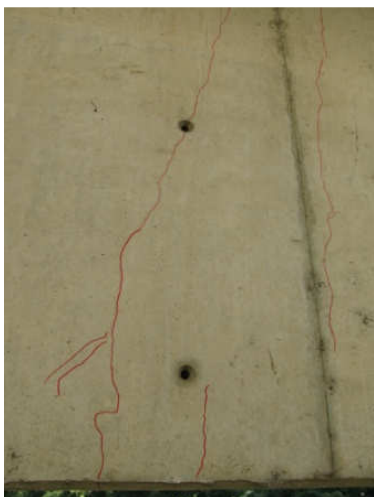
Vista face externa da longarina V1 (fissuras por flexão), entre os pilares P5A e P4A e transversinas TR16 e TR 15.
